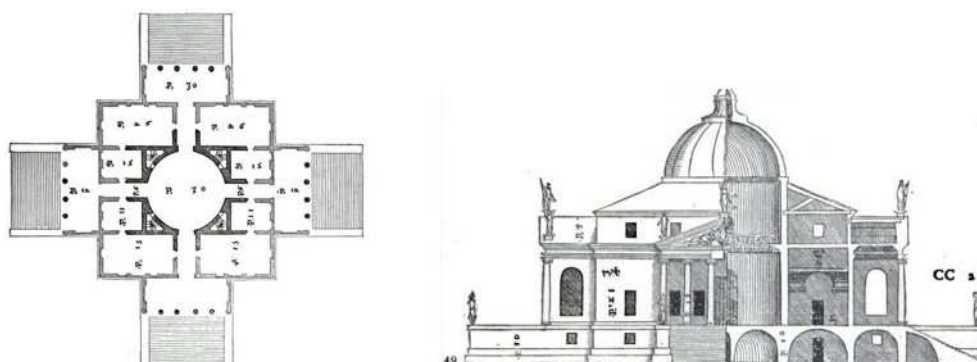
La Rotonda*, planta e secção. (Palladio, 1570, p.19)
